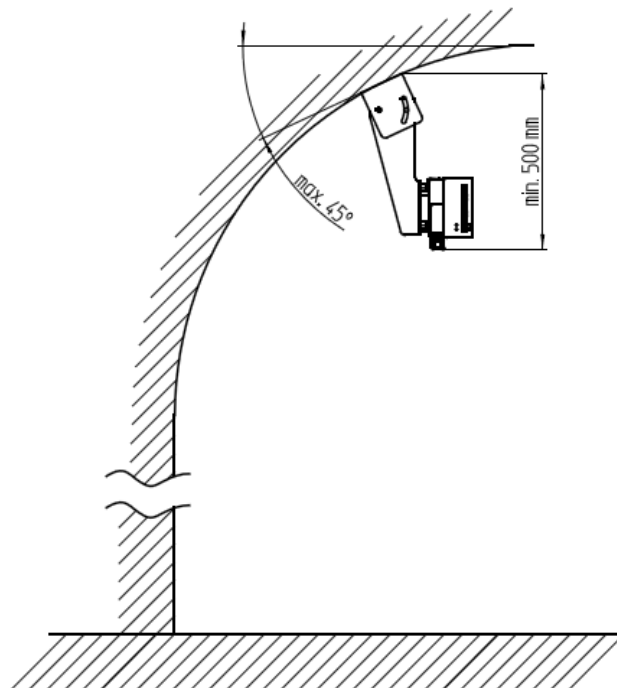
Min. Abstand zur Decke bei Wandmontage
